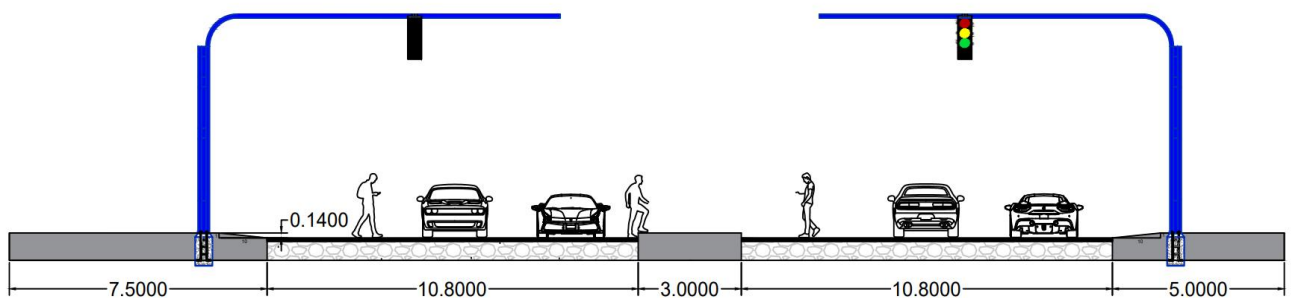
Vista en alzado del dimensionamiento de la facilidad peatonal
